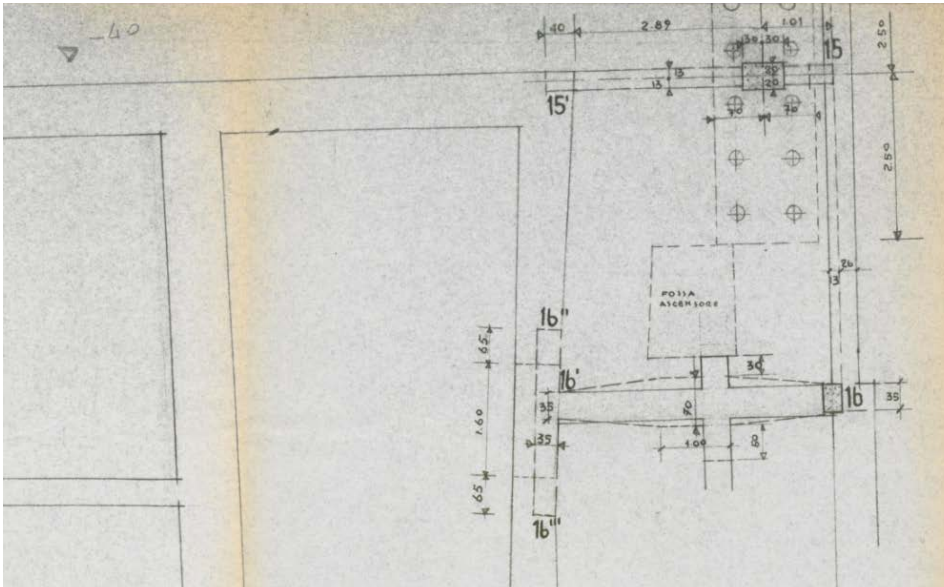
Estratto tavola fondazioni (1960) - (Archivio del Comune di Padova)
